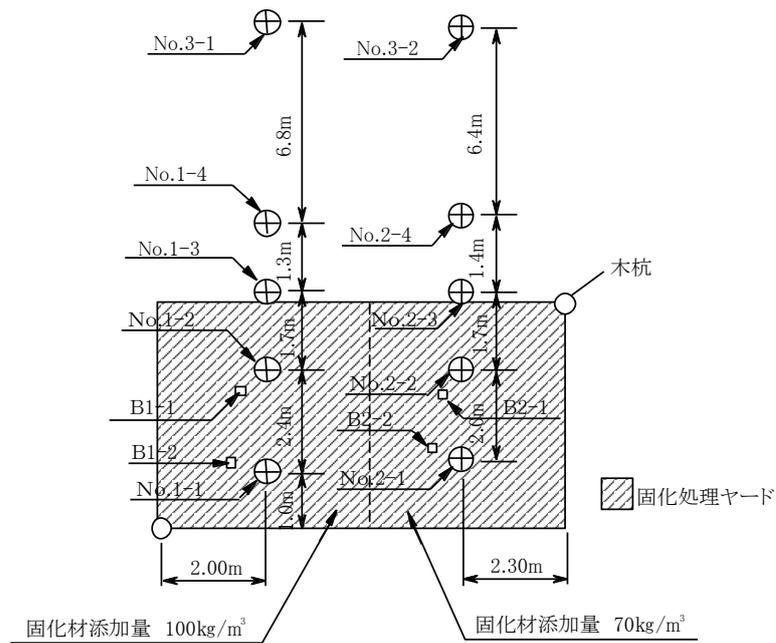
調査地点位置 (平面図) <sup>5)</sup>
